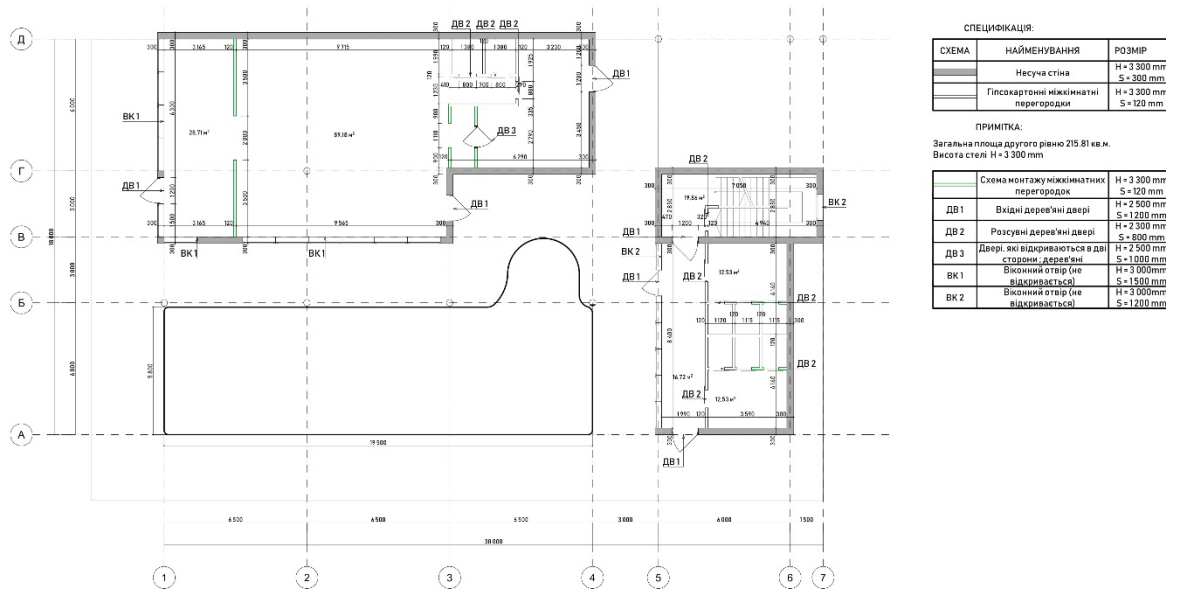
Схема монтажу міжкімнатних перегородок першого рівню
